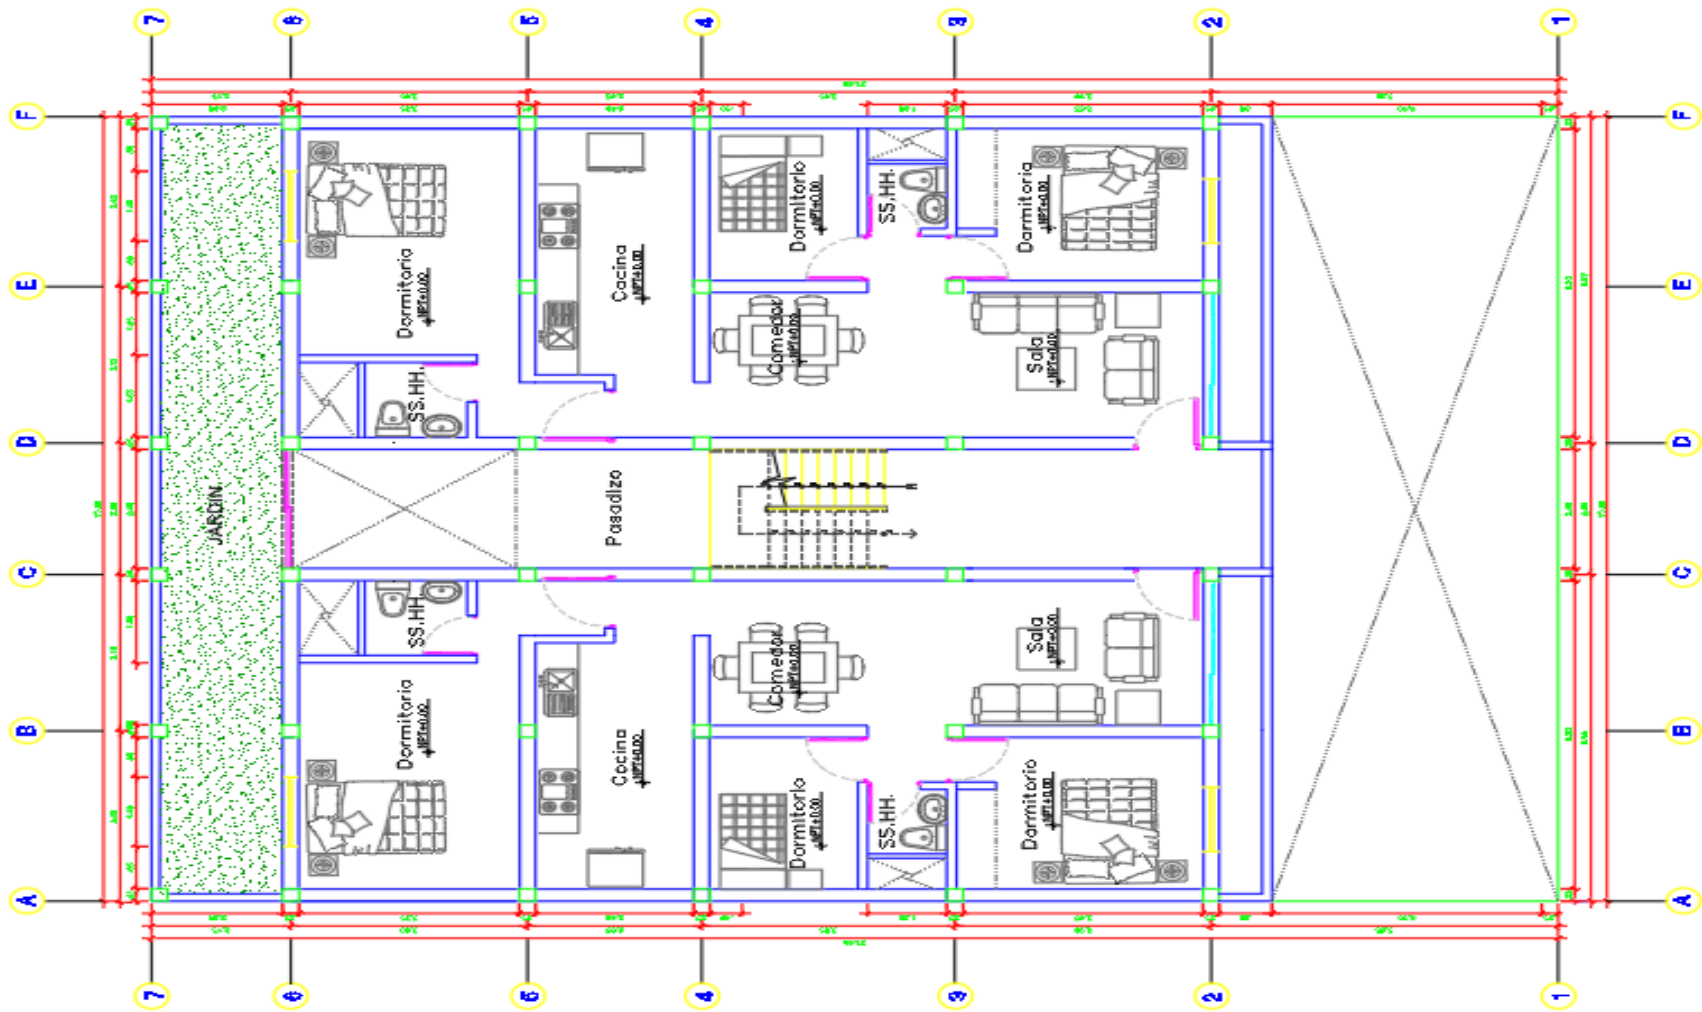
Plano de distribución del 2do al 5to Nivel – Albañilería armada Placa P-14
